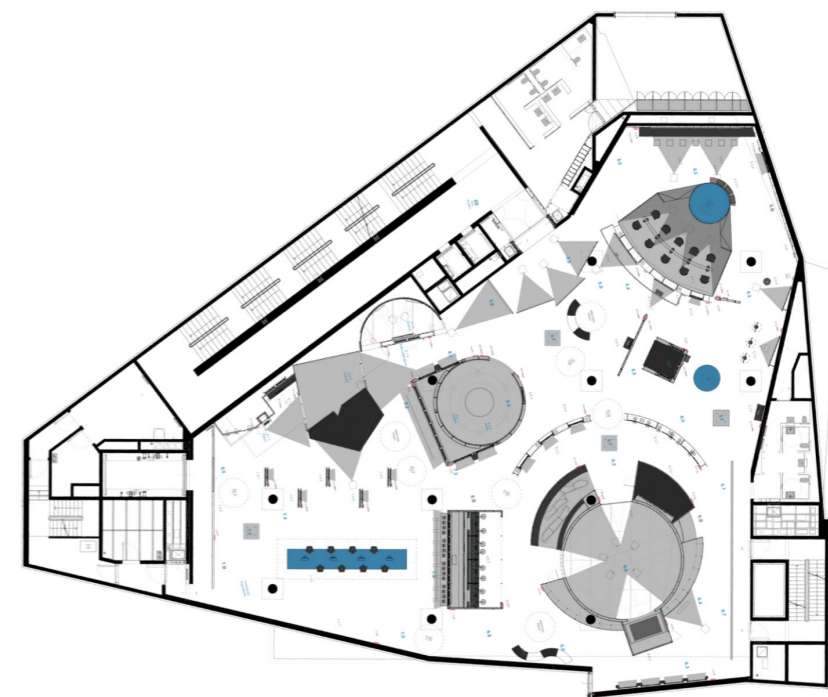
PIANTA PIANO SECONDO MUSEO M9 (FONTE: RNB4CULTURE, 2021).
